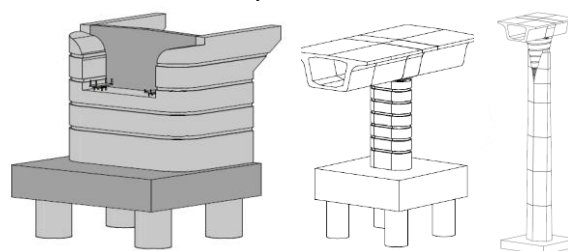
Figuras 3D del estribo 1, pila 1 y pila 5.
